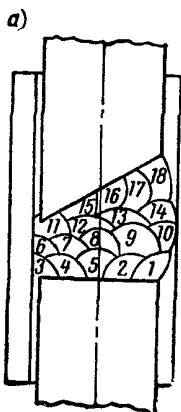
Техника полуавтоматической дуговой сварки стыкового соединения вертикальных стержней многослойными швами
